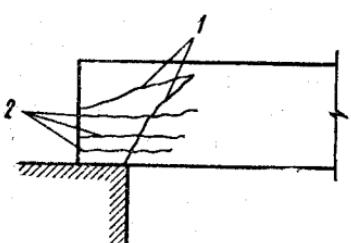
Трещины в опорной части предварительно напряженного элемента:
